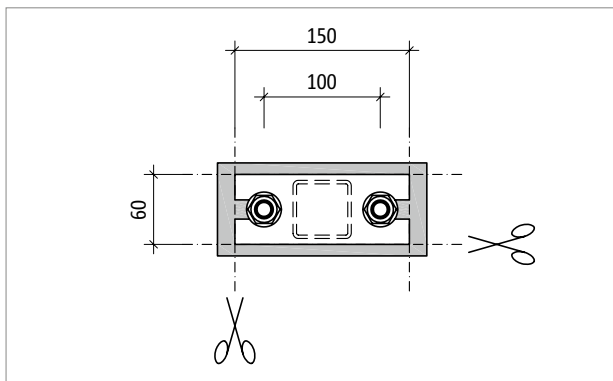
Schöck Isokorb® T type S-V : dimensions après découpe du corps isolant
